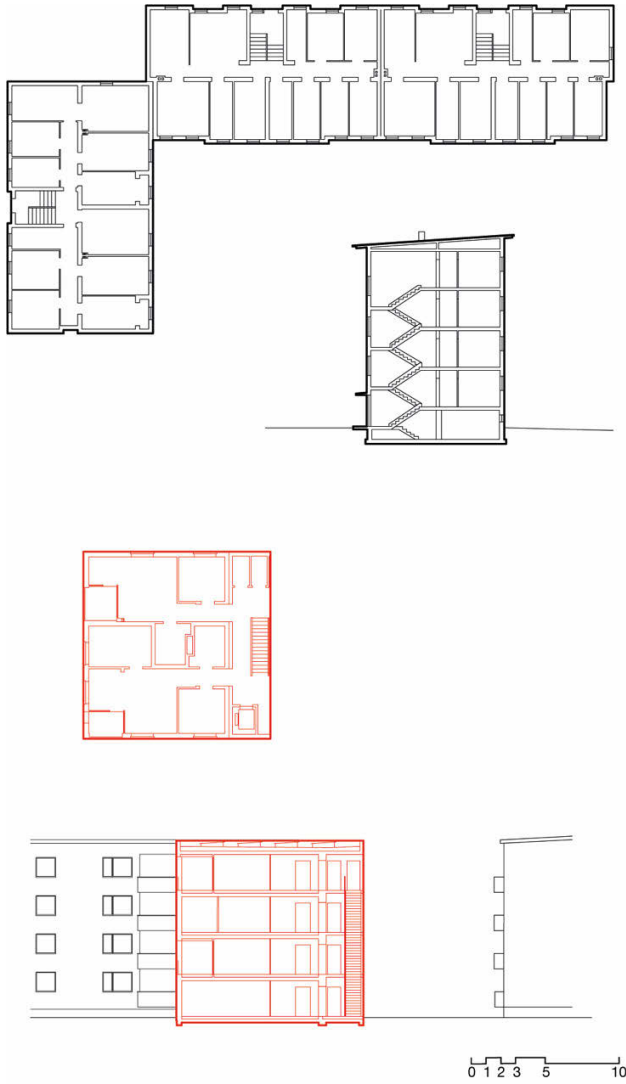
Grundrisse & Schnitte Bestand – Nachverdichtung, Bremer Punkt
